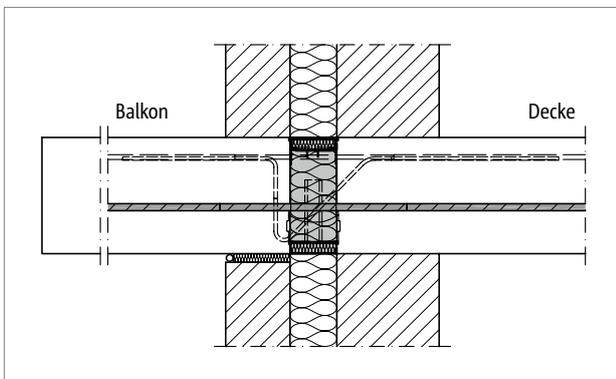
Schöck Isokorb® T Typ KL, HP-NN: Mauerwerk mit Kerndämmung
